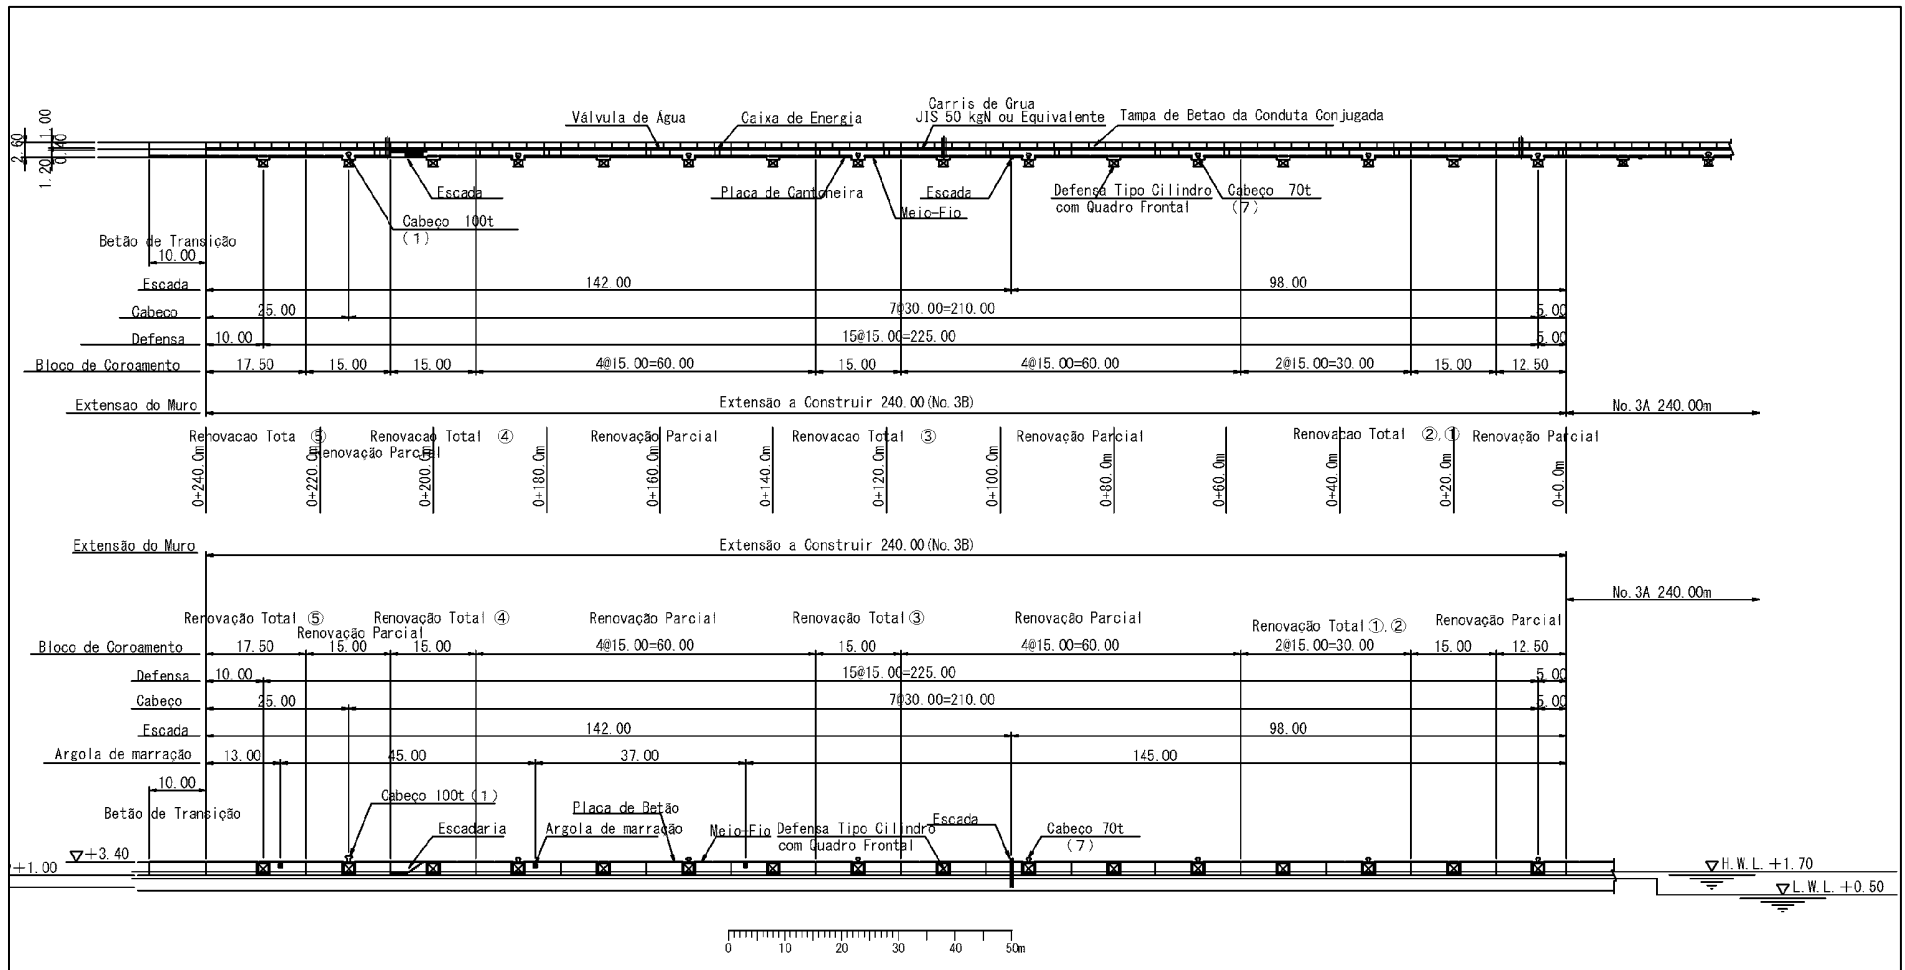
Planta Planimétrica da Reabilitação da Zona 3B
